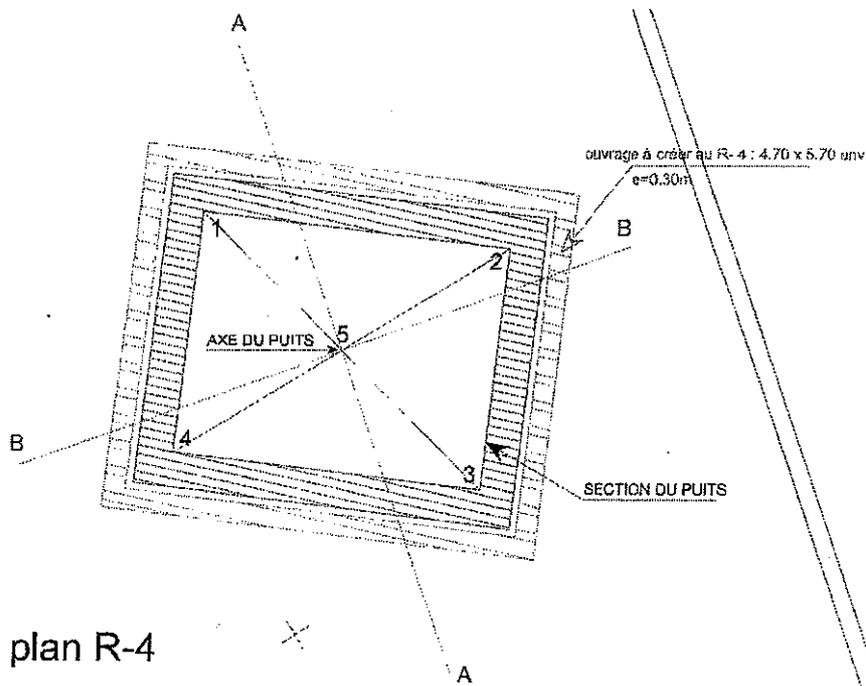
Vue en plan des ouvrages à réaliser au niveau R-4
